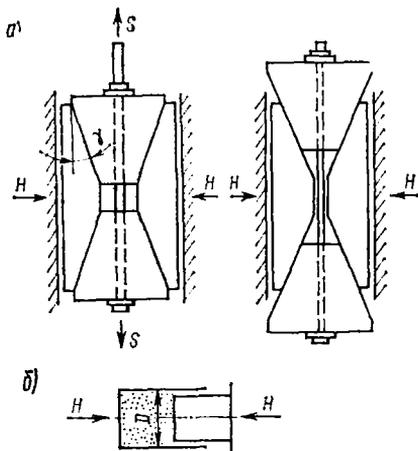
Схемы к расчету приборов для раскружаливания
